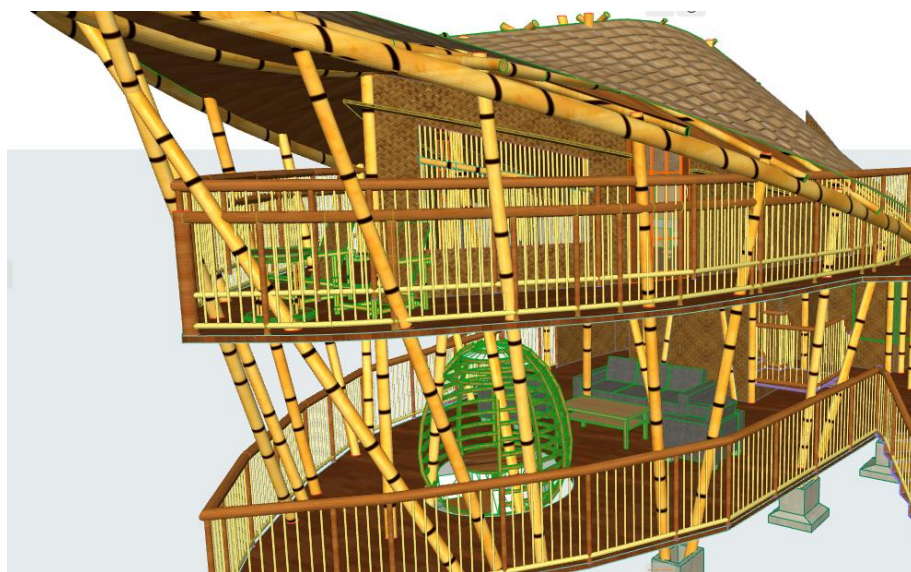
9 Tampak Depan dan Belakang Bangunan Cottage Standard
